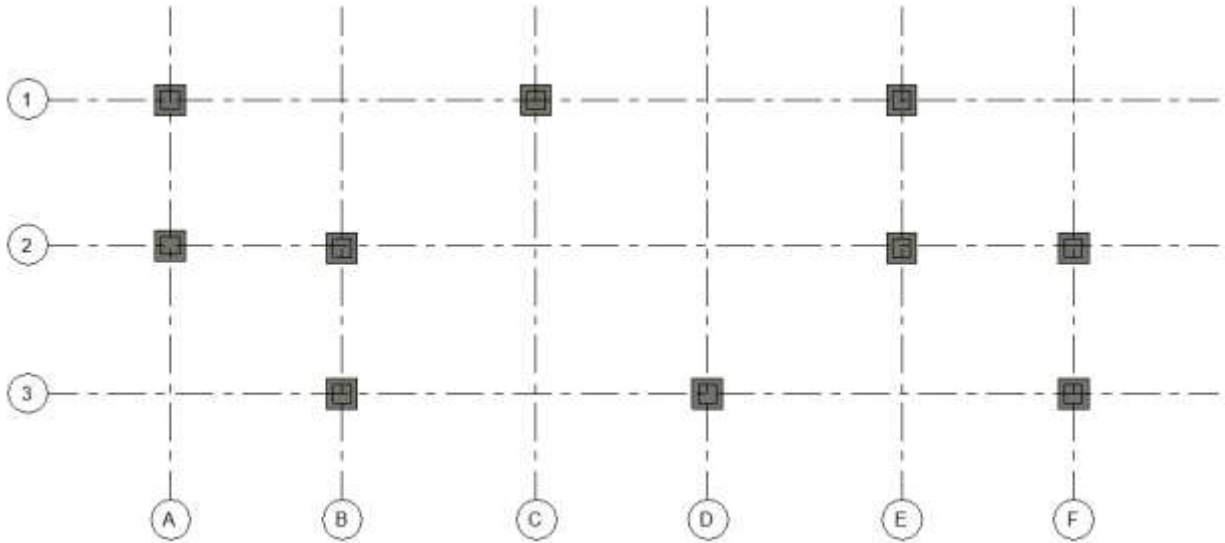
, Cimentación en modelo Revit #1, 2025-II, Wilson Lozano
